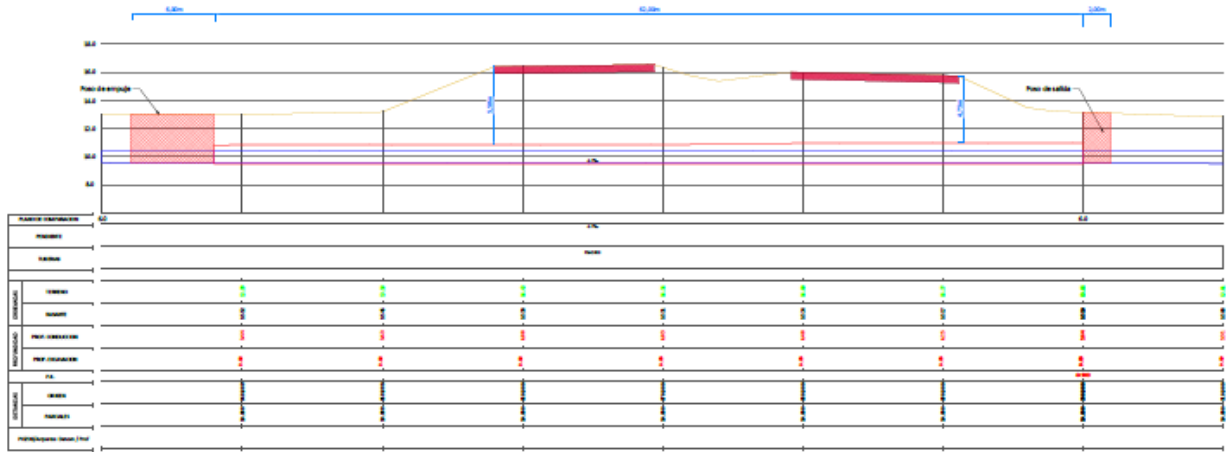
Alzado tramo en hinca cruce con AP-7.
